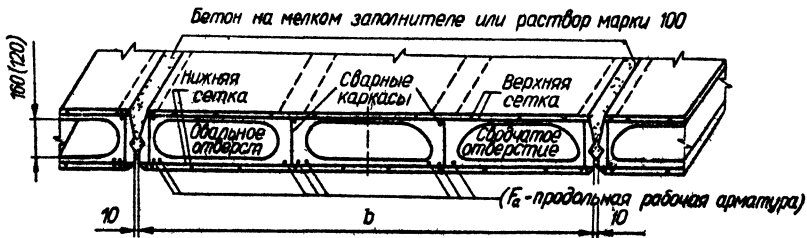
Многопустотные панели с овальными сводчатыми отверстиями, в которых ребра армируются сварными каркасами, а плиты — сварными сетками.
